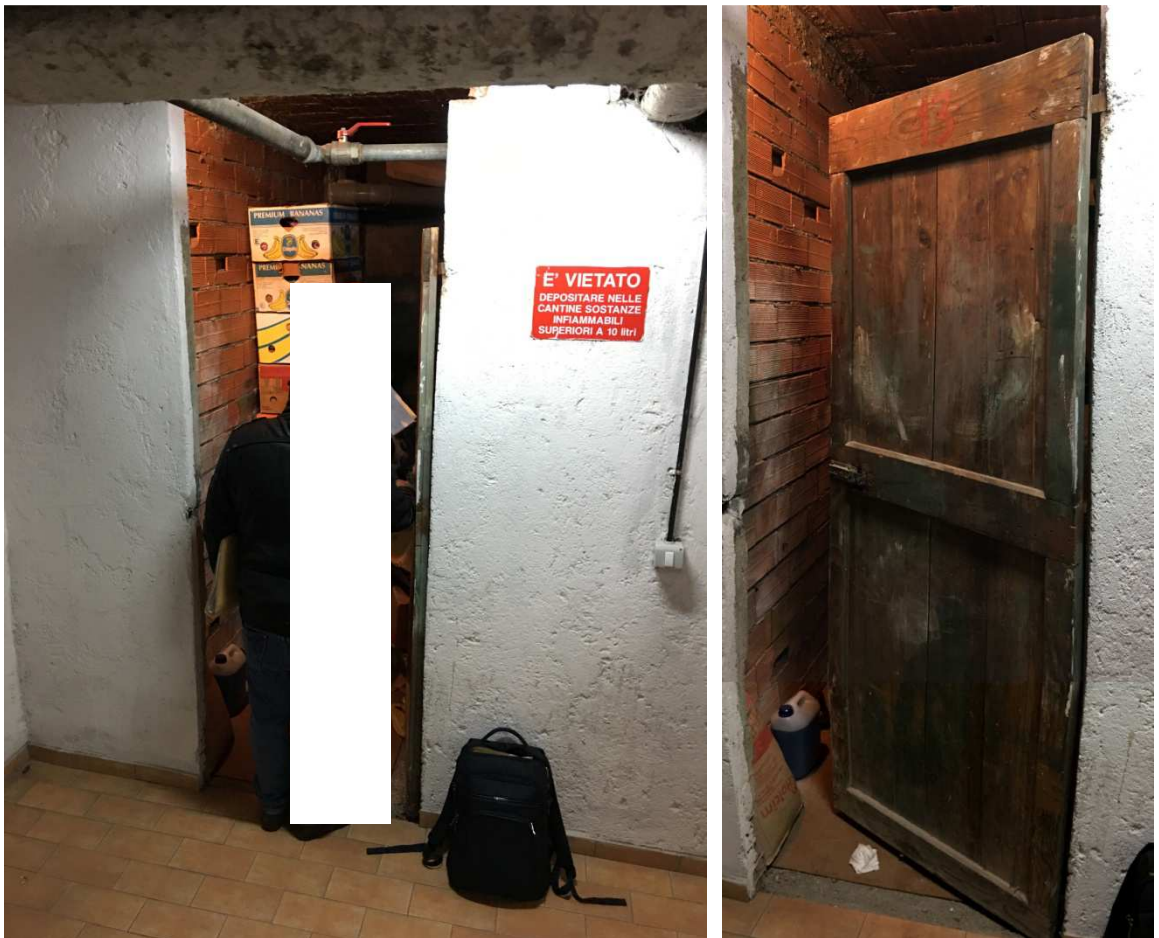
Piano Seminterrato. Vano cantina
